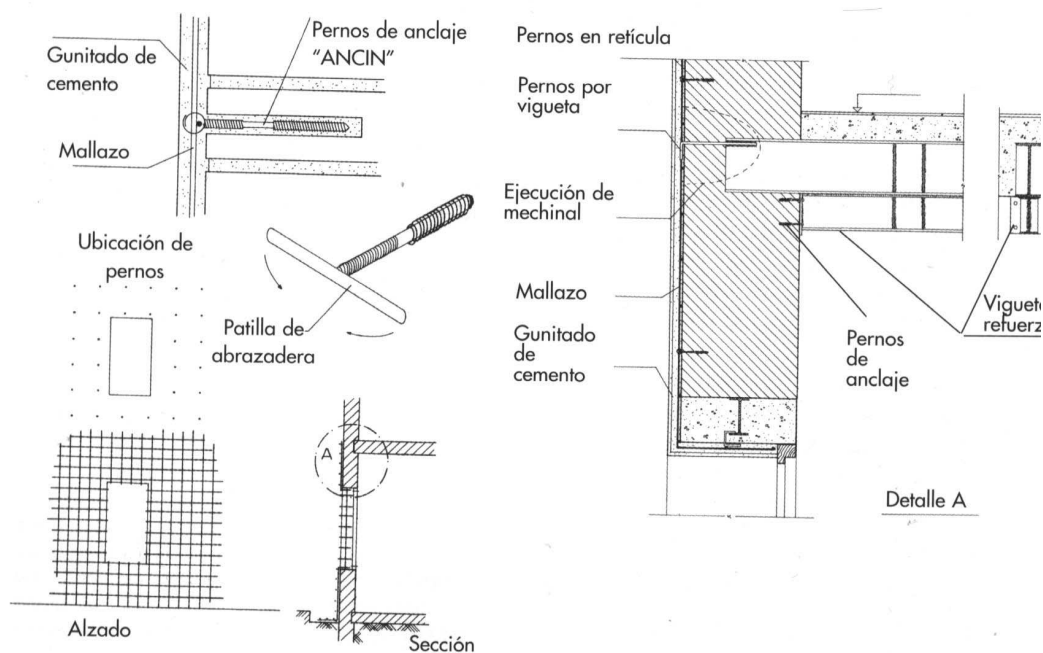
a. Refuerzo de un muro mediante recrecio de su cara exterior con mortero gunitado.
